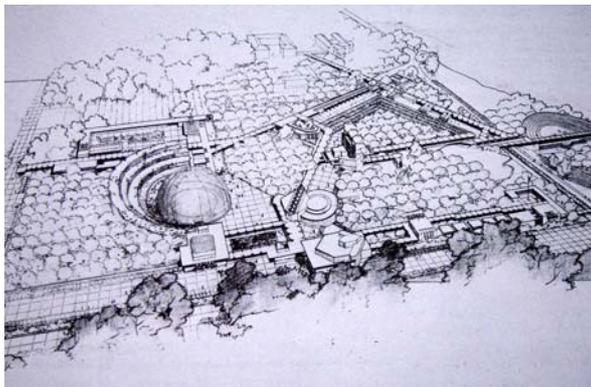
Florida Southern College. Plano para o *campus* (1938). Construção (anos 40).
